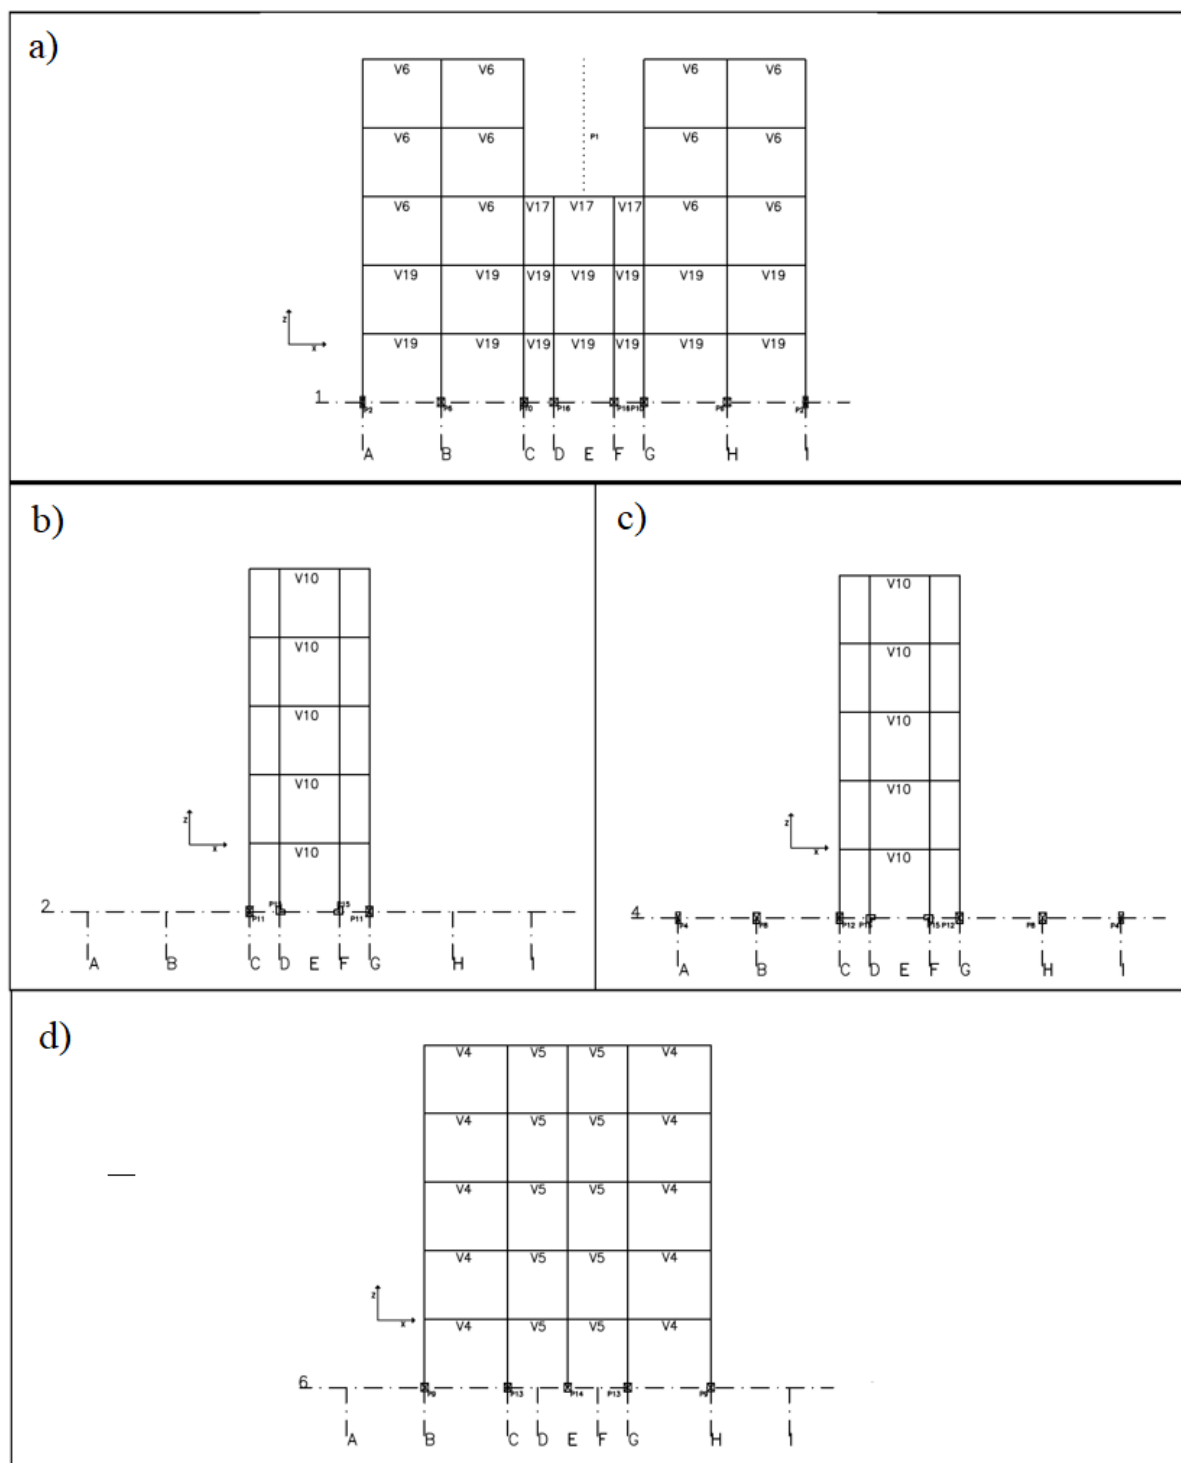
Pórticos em X: a) pórtico 1X; b) pórtico 2X; c) pórtico 4X; d) pórtico 6X.
